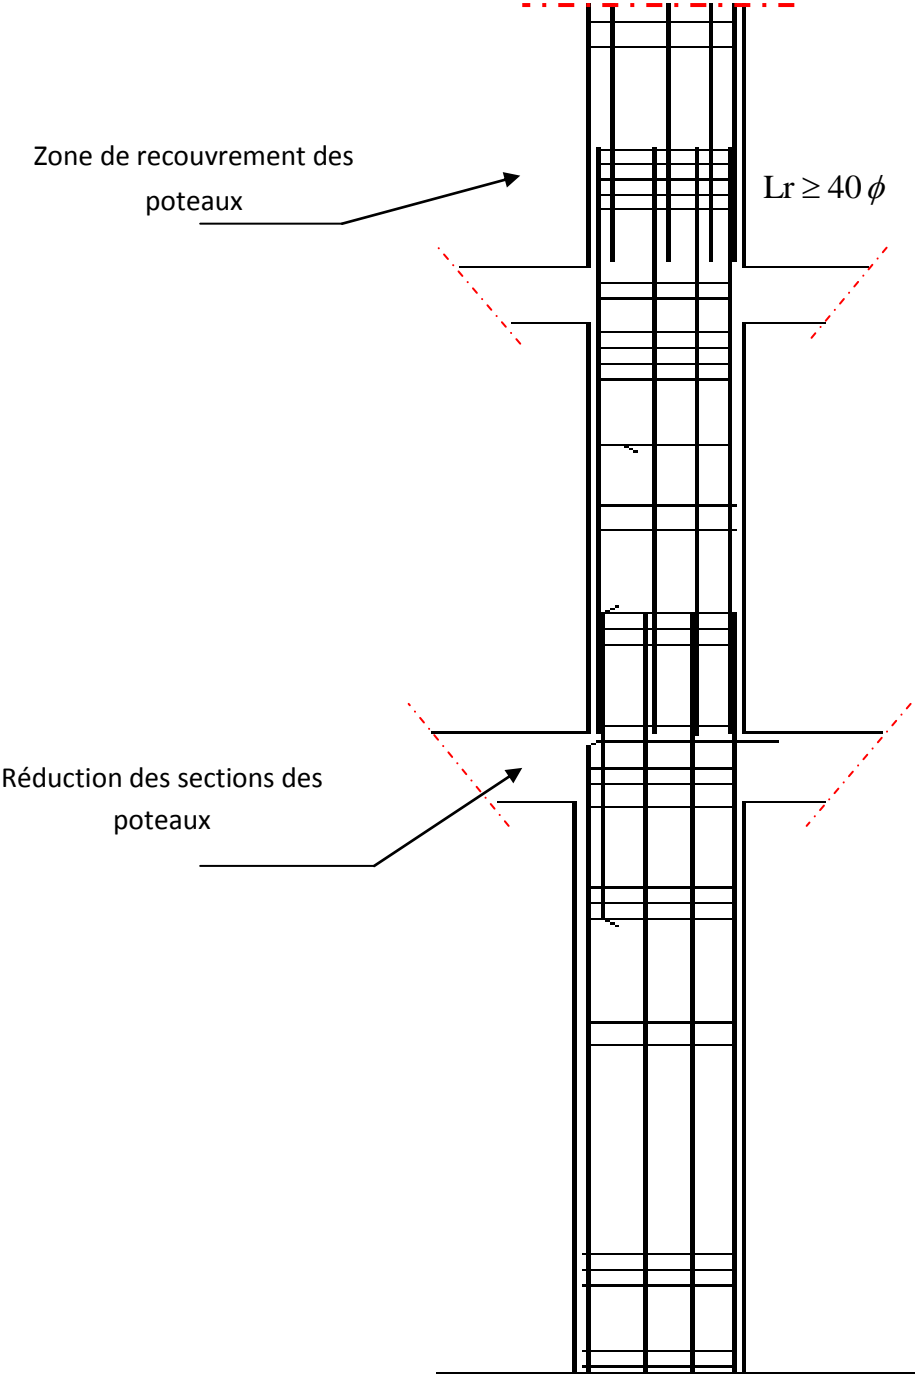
Disposition constructive des armatures des poteaux.
